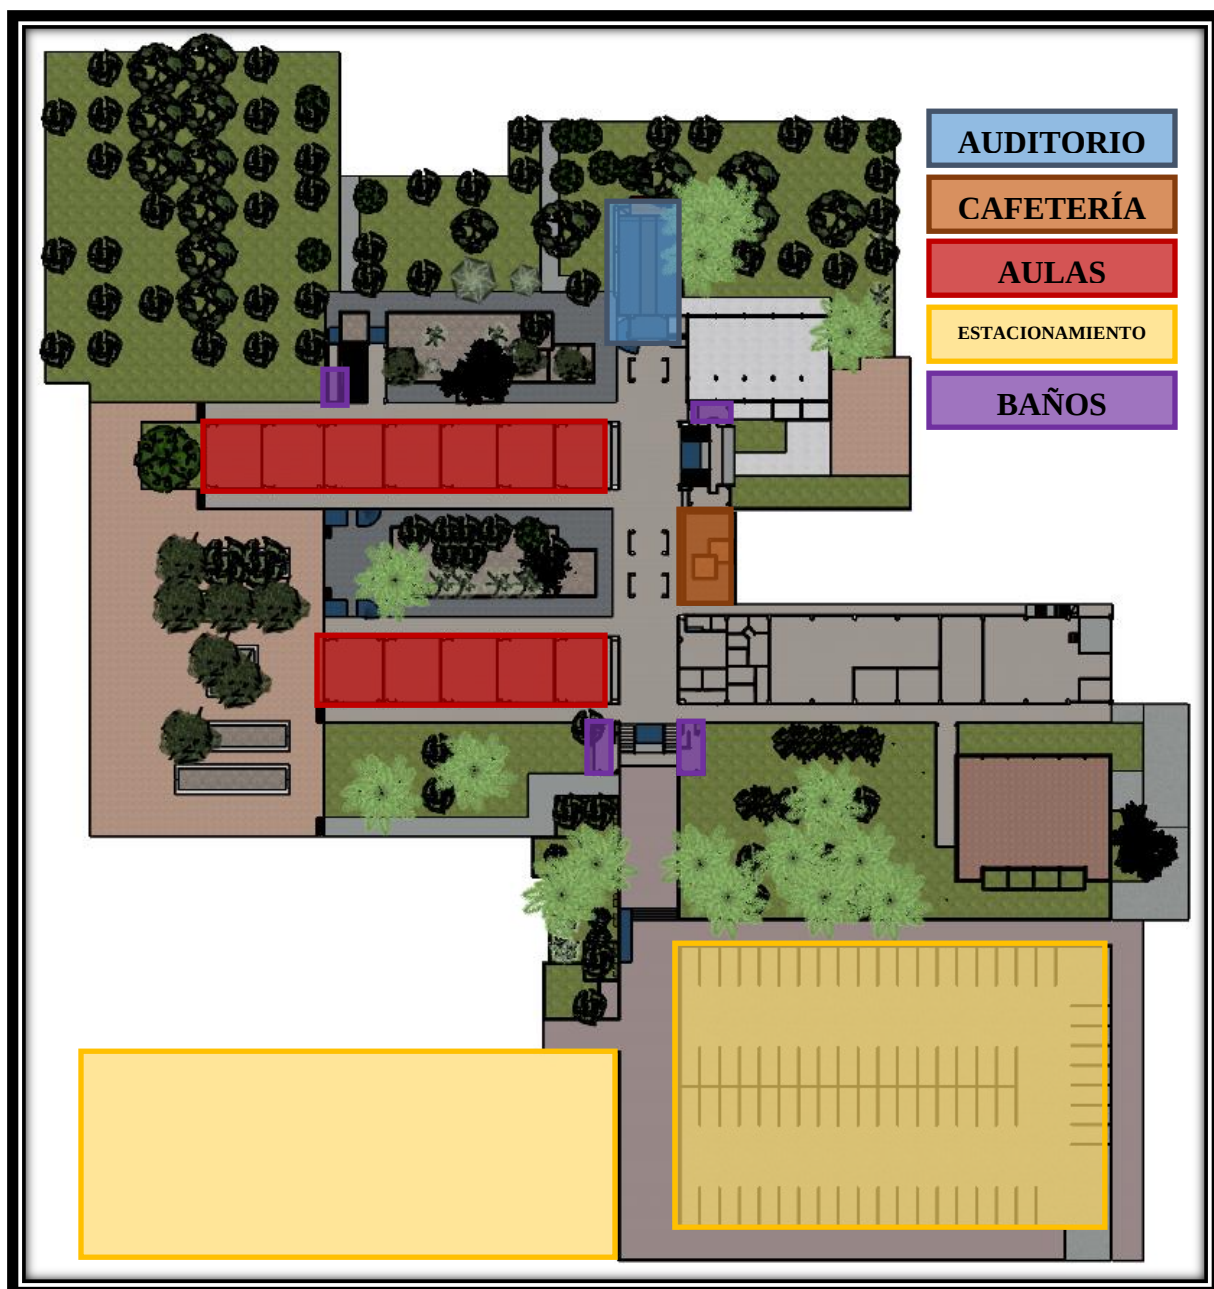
Planta de Conjunto de la FIC- Localización de las Áreas. Elaboración Propia
